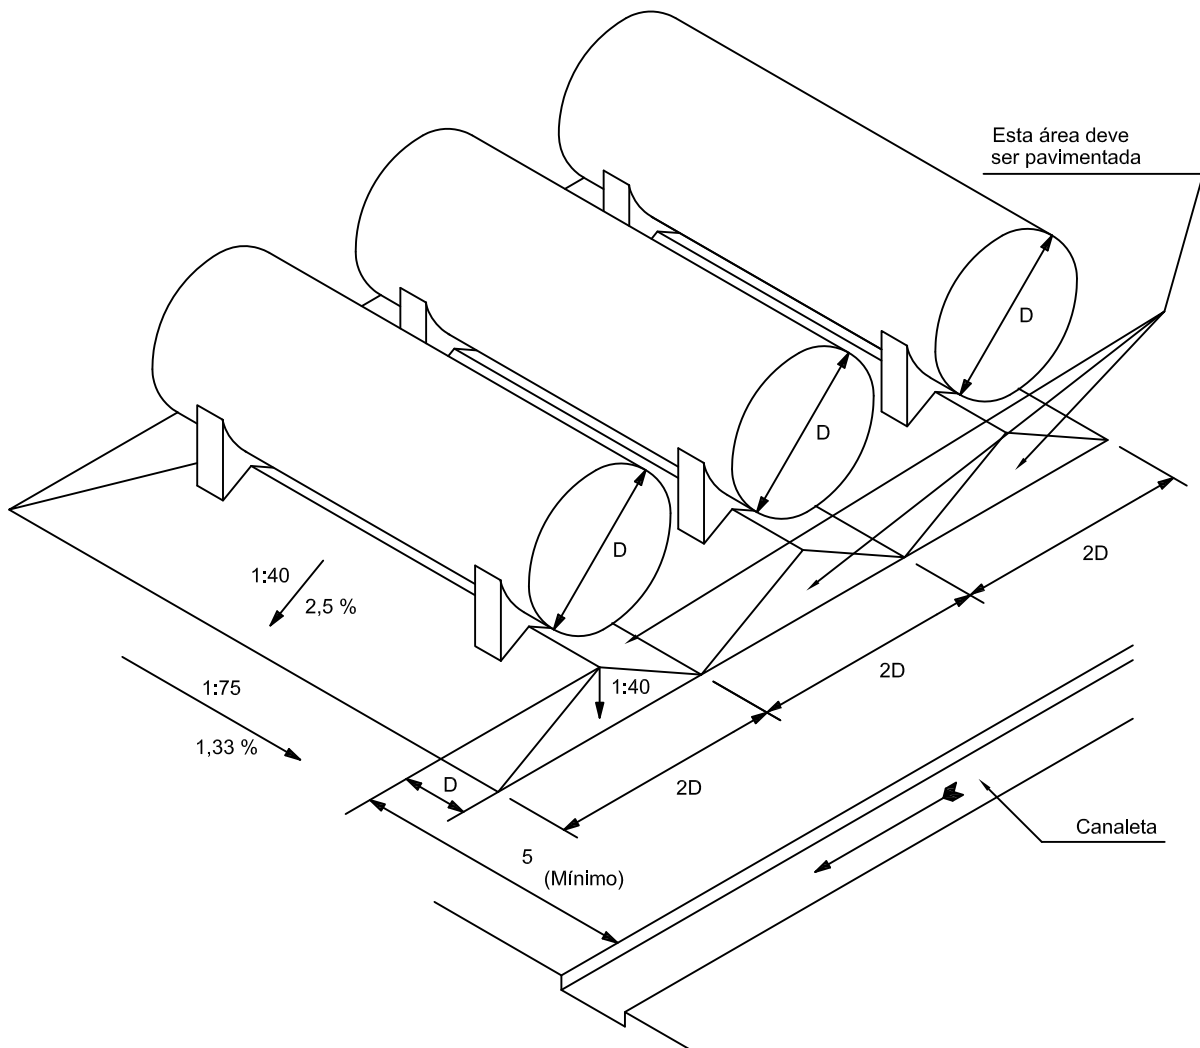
Pavimentação sob Cilindros e Sistema de Drenagem Superficial
